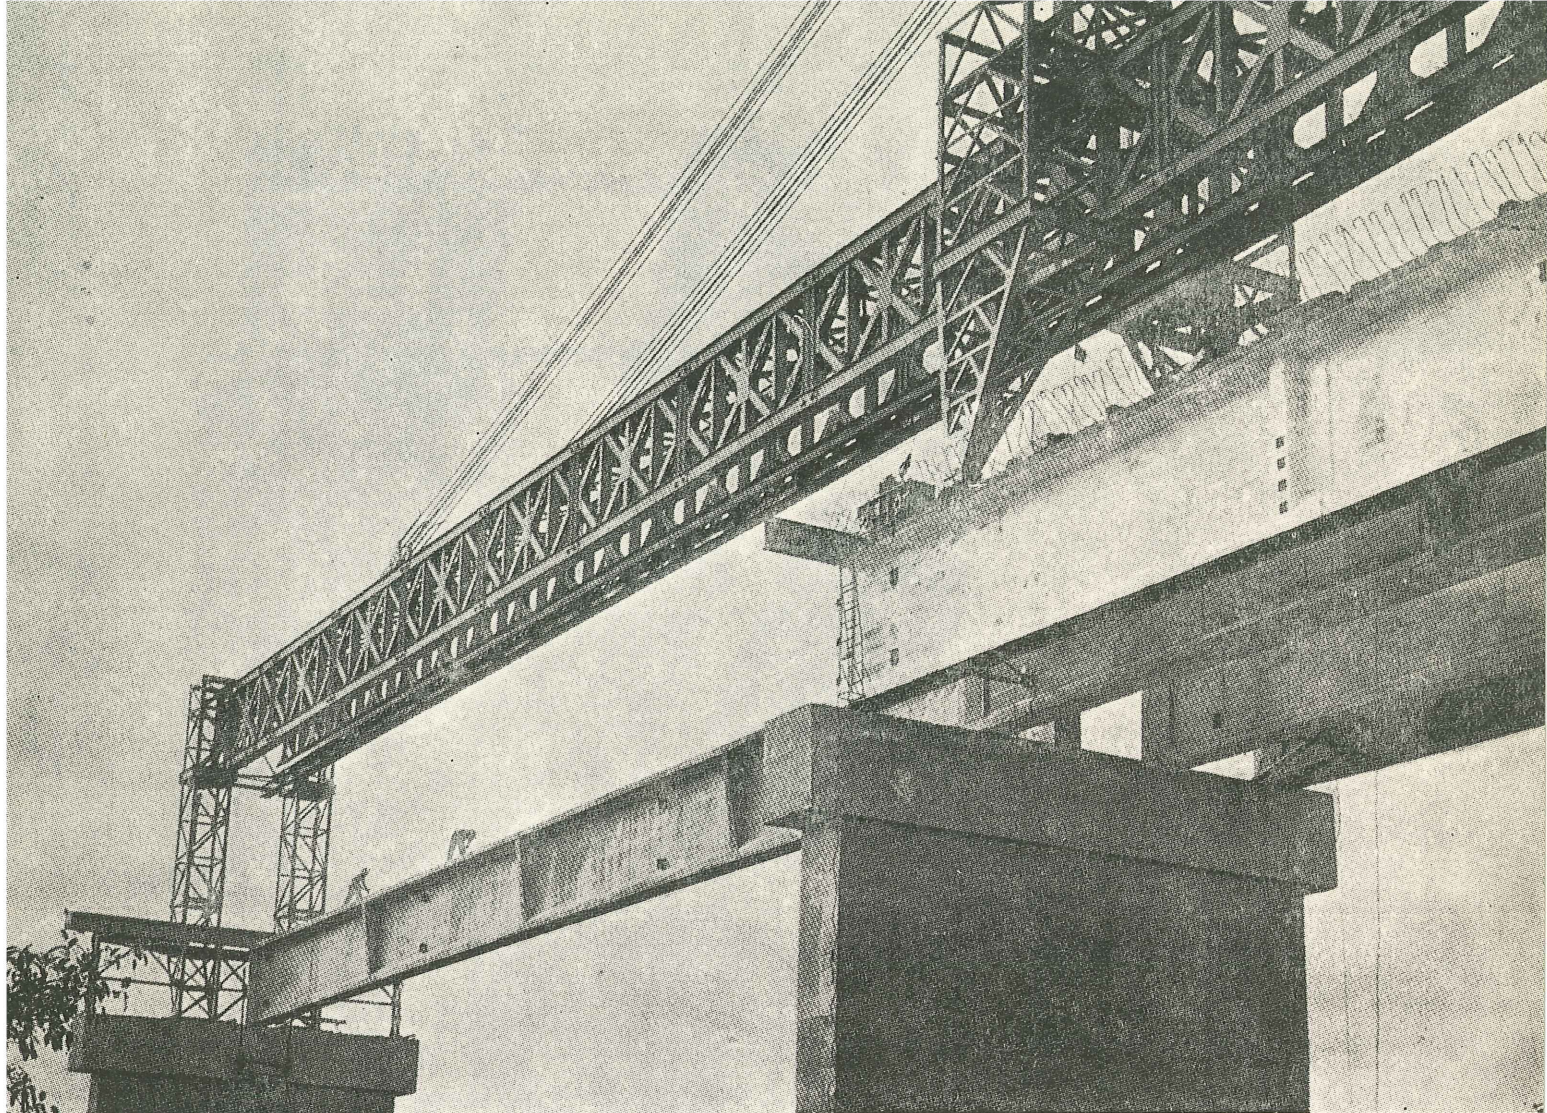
Puesta en obra, mediante el adecuado aparejo de lanzamiento de una de las vigas pretensadas
